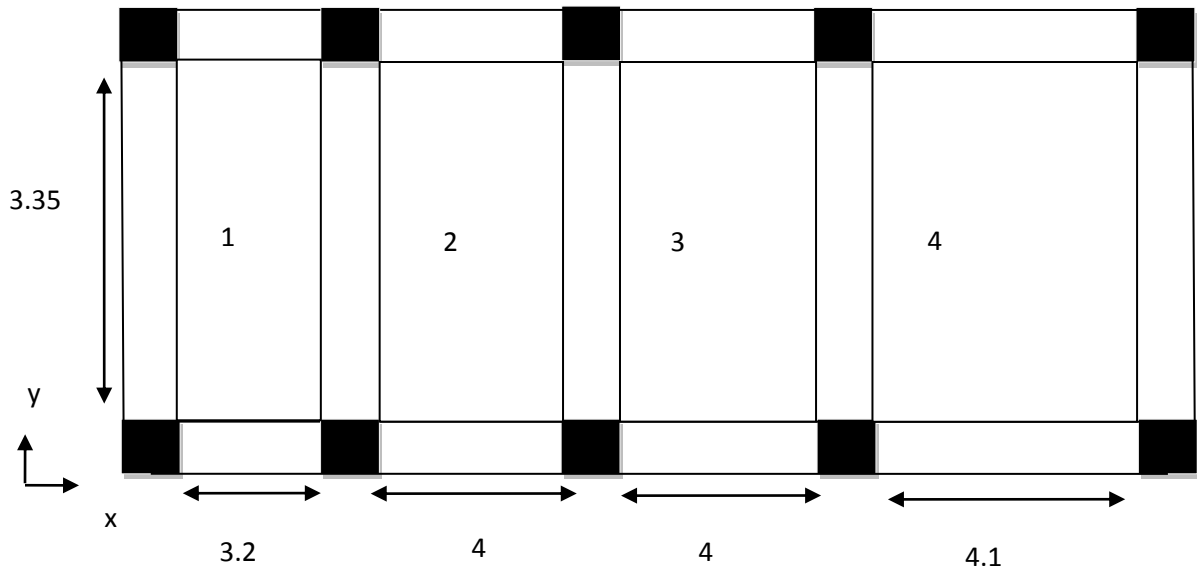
Vue en plan de plancher qui couvre les conduites de refoulement
